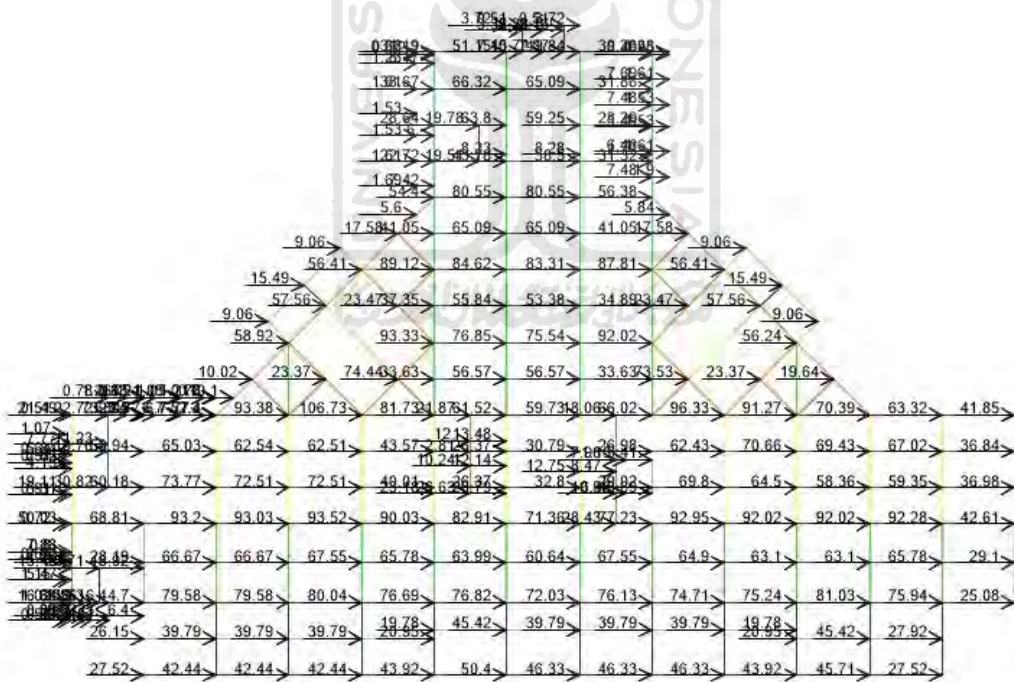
15 Gaya Joint Load Fpx Arah Y pada Lantai 1
